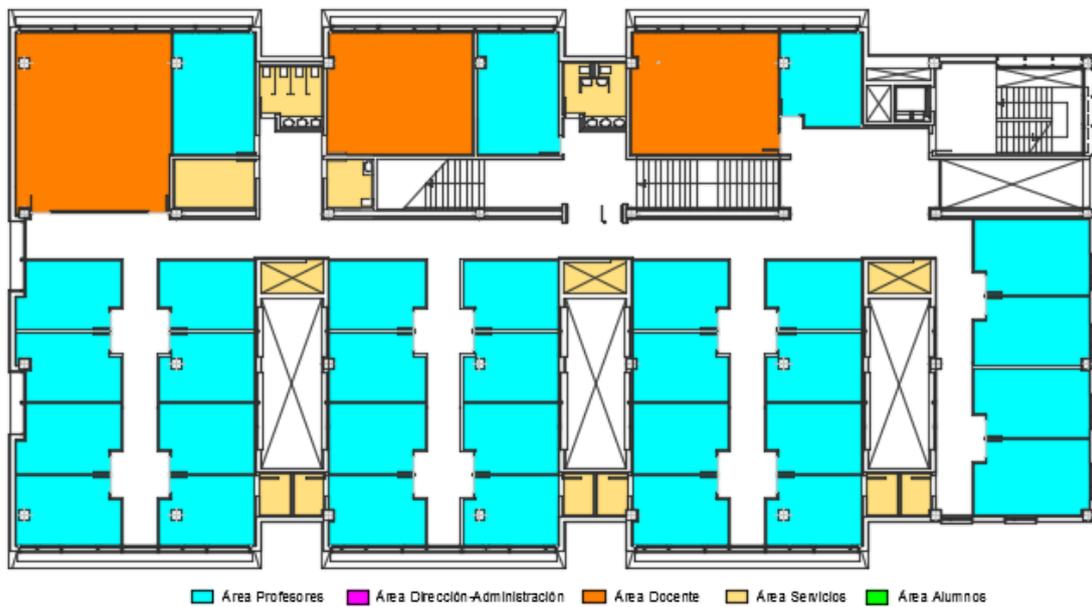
Esquema funcional Planta Segunda. Figura extraída del plano 38.
